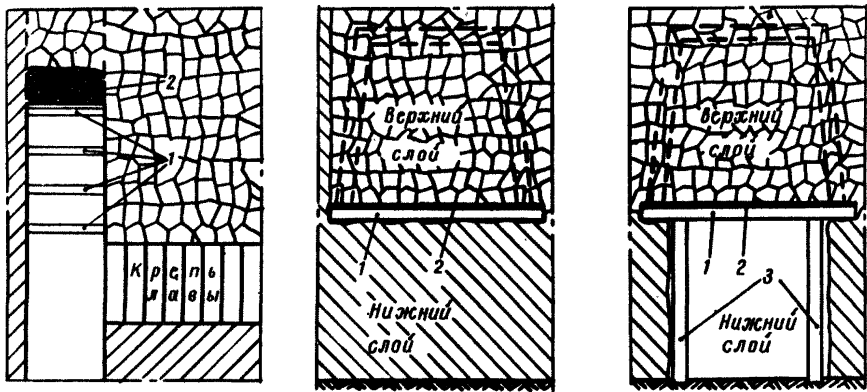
Способ предварительного крепления выработок со стороны кровли по нижележащему слою путем укладки верхняков и перекрытия в вышележащем слое:
